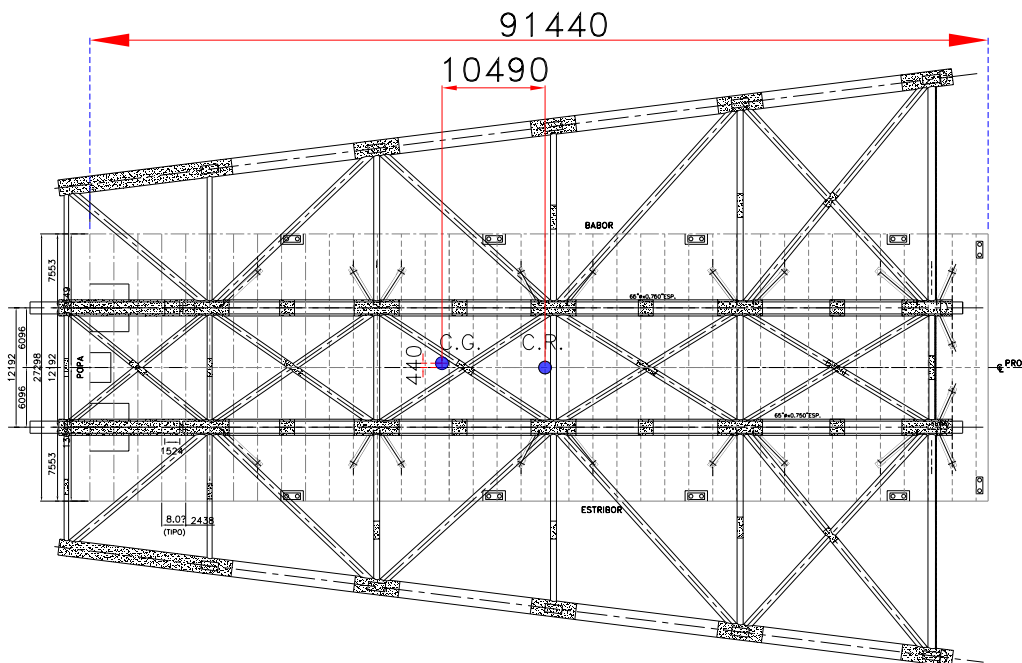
Ubicación en planta del centro de rotación y el centro de gravedad de la estructura en la barcaza de transportación
